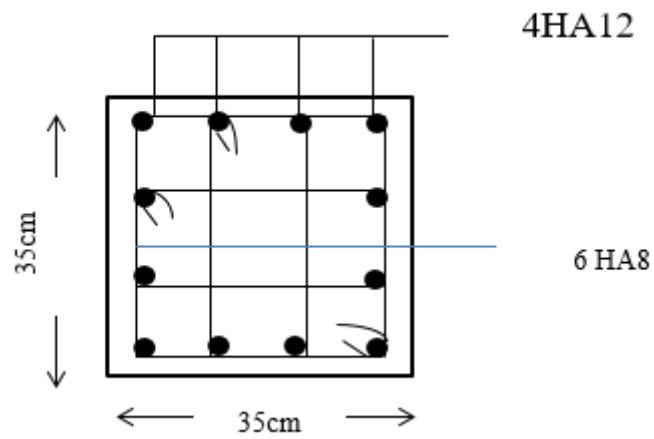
Schéma de ferrailage des poteaux du 5^{ème} et 6^{ème} étages.
